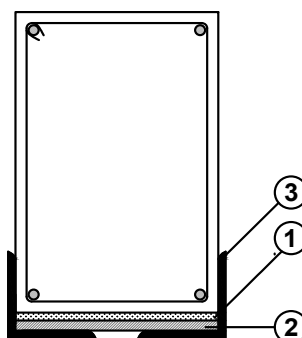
Tipologia 3: representação da secção transversal da viga reforçada. Legenda: 1 – resina epóxi; 2 - chapa metálica; 3 - bucha metálica; 4 – fissuração no betão.
